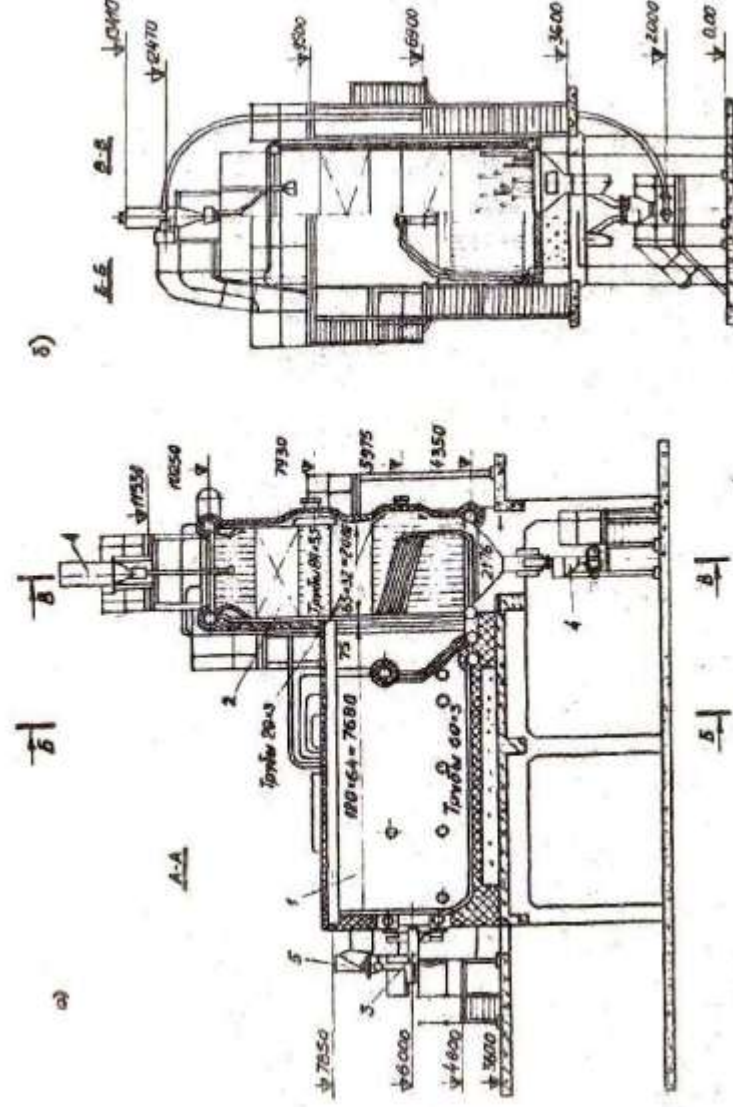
Общий вид газомазутного водогрейного котла типа KB-ГМ-30: а – поперечный разрез; б – продольный разрез; 1 – топочная камера; 2 – конвективная шахта; 3 – газомазутная горелка; 4 – дробеочистка; 5 – взрывные клапаны
